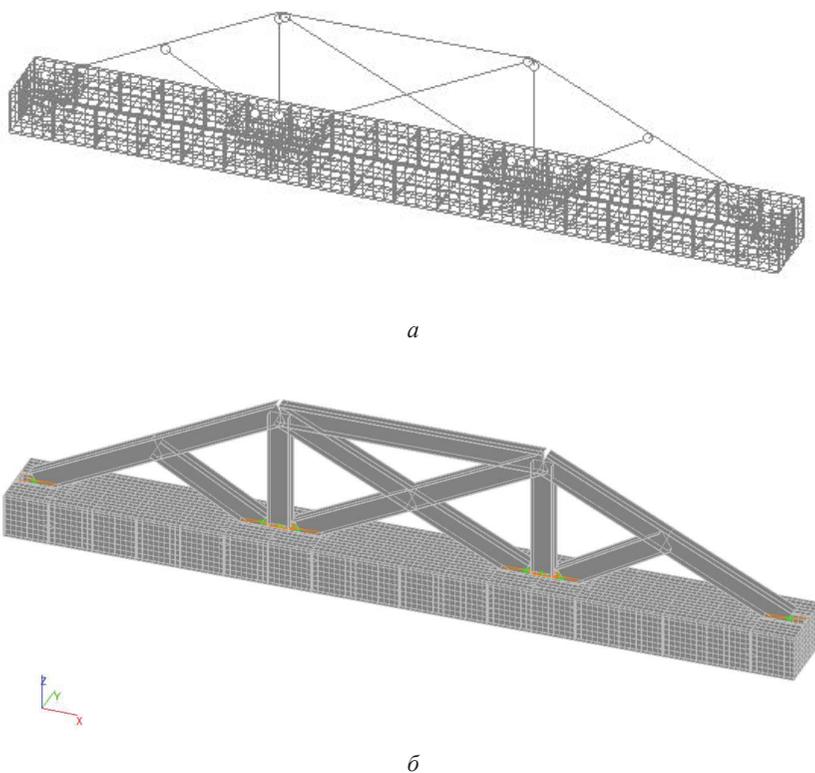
Расчетные схемы ППФ: а – с шарнирным примыканием элементов решетки к нижнему поясу ППФ; б – с жестким примыканием элементов решетки к нижнему поясу ППФ
